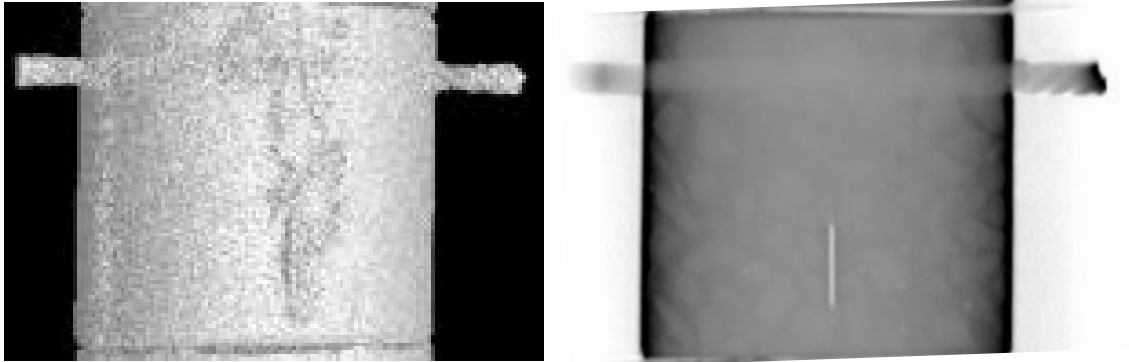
2. 3-5 ひび割れを導入した試験体（左）及び中央部断面像（右）
